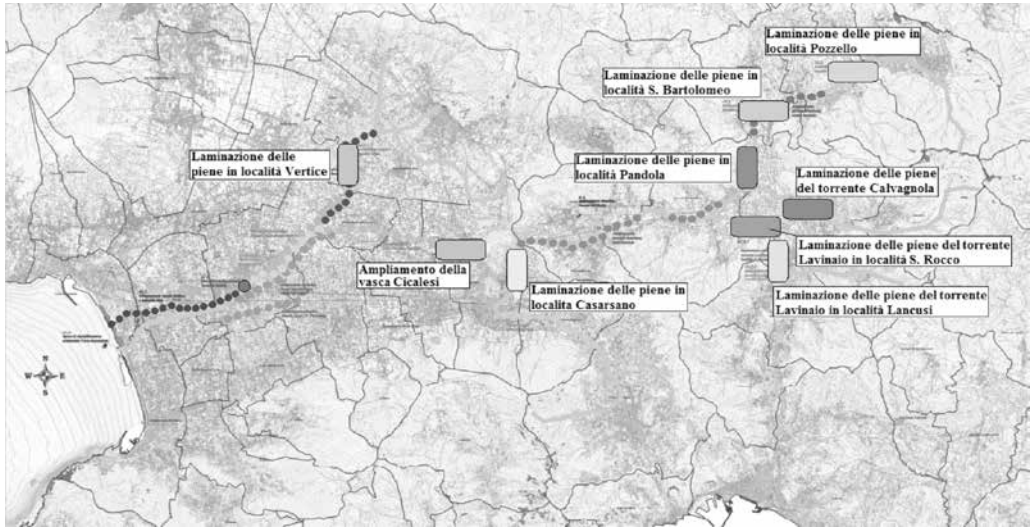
Planimetria generale degli interventi previsti dal Grande Progetto Sarno
